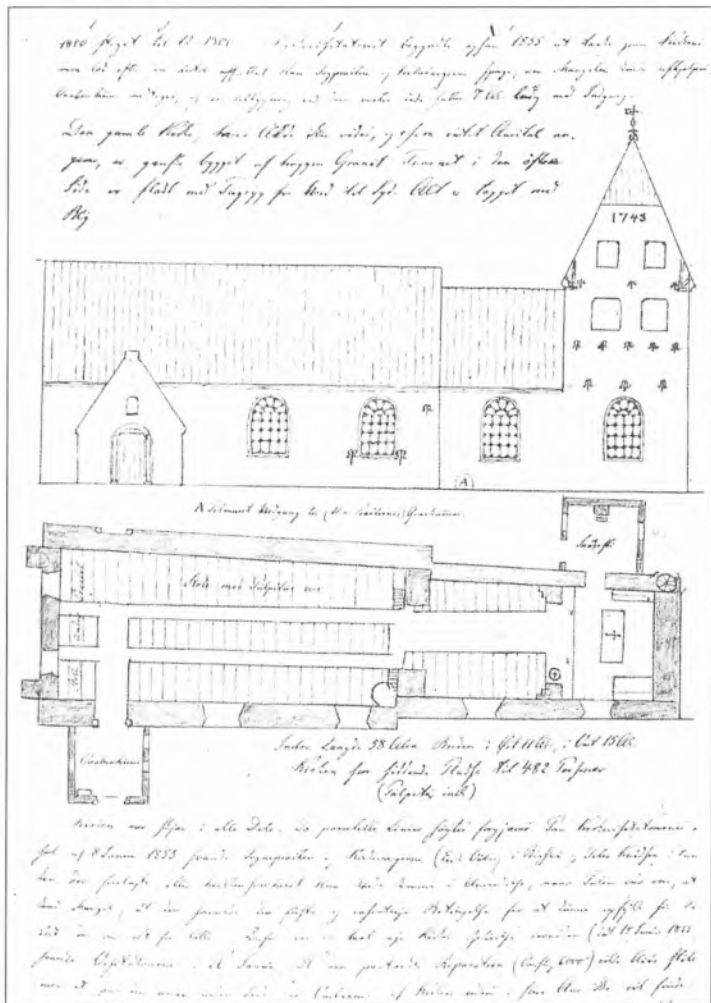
Tyrstrup Kirke. Skitseret plan og opstalt af sydfacaden, udført 1851. Plan: Danmarks Kirker.
